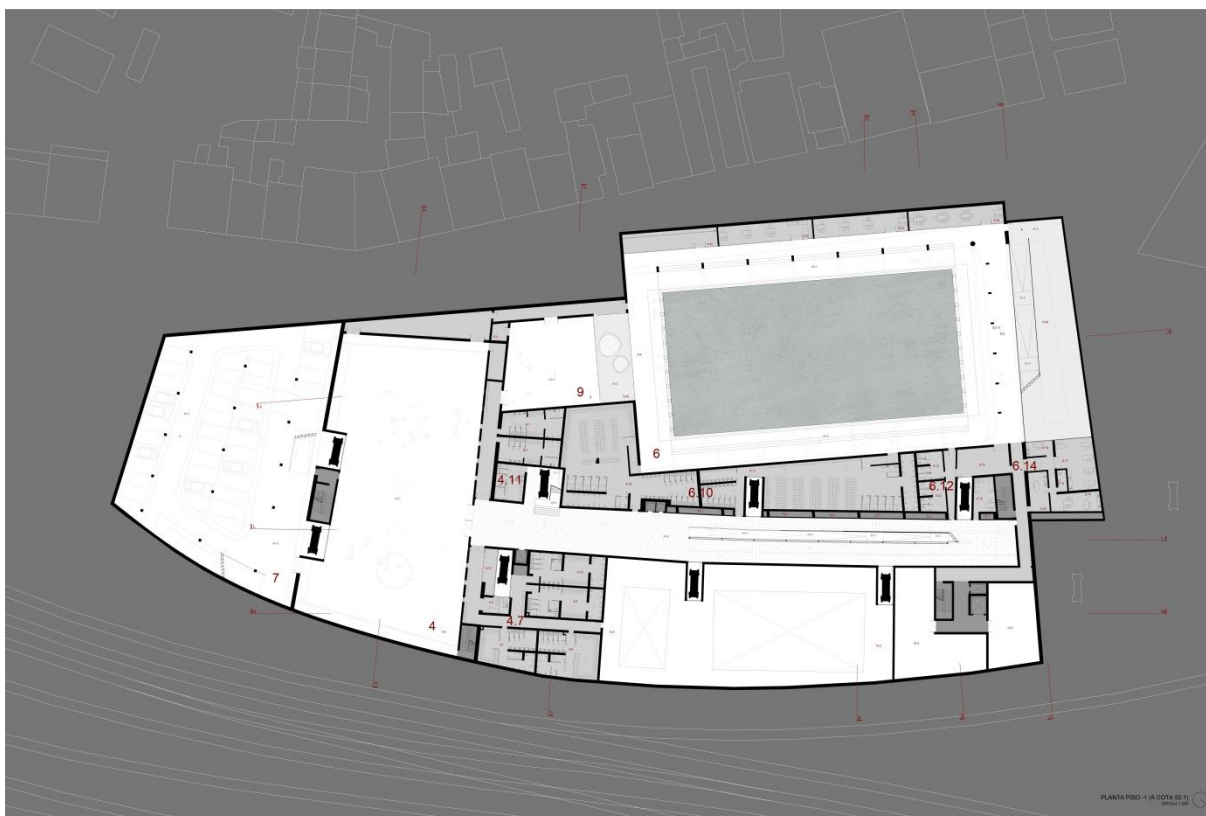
Planta Piso -1 – localização dos espaços principais.
